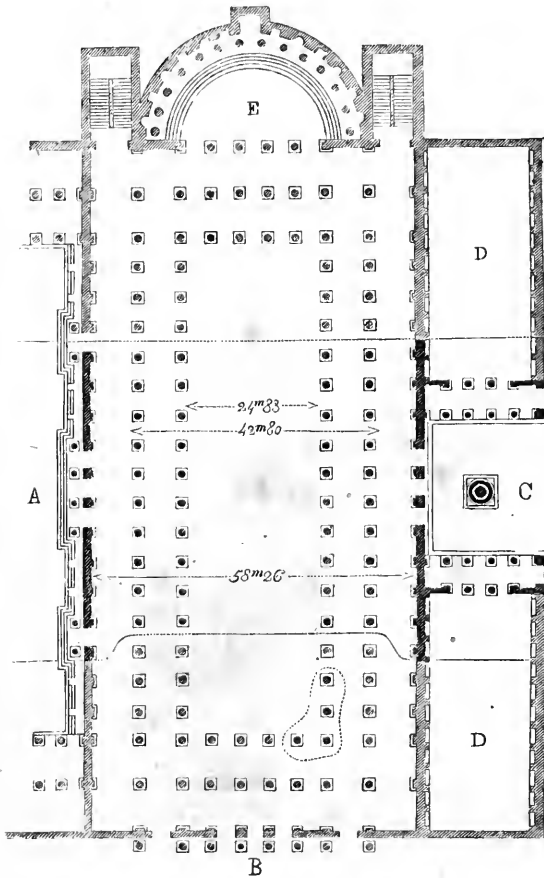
Grundriss der Basilika Ulpia.
